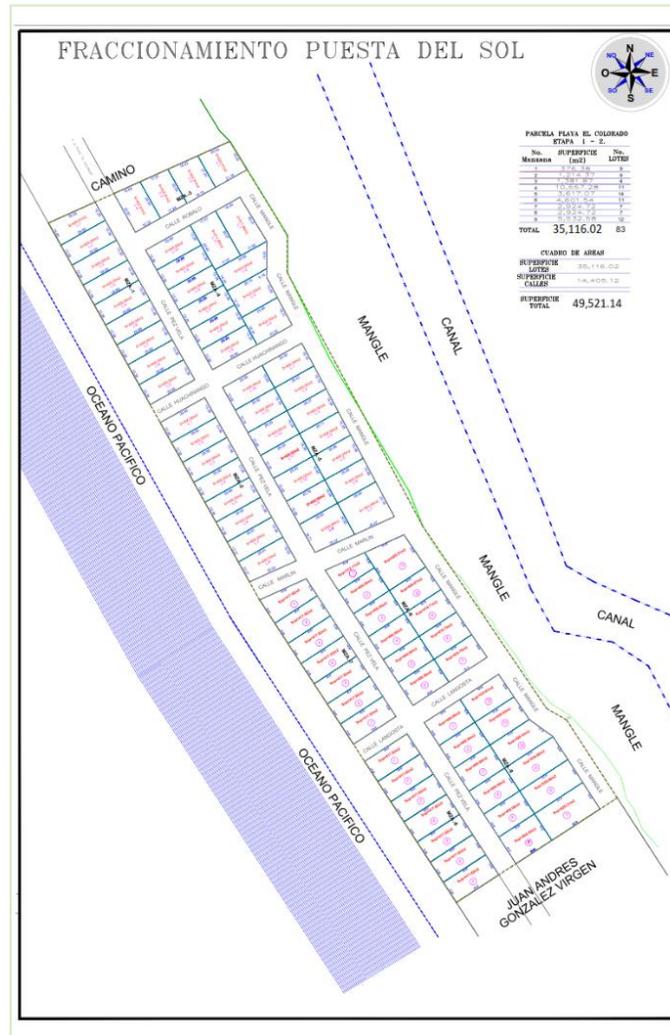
Diagrama de obras, donde se muestra las vialidades a construir
